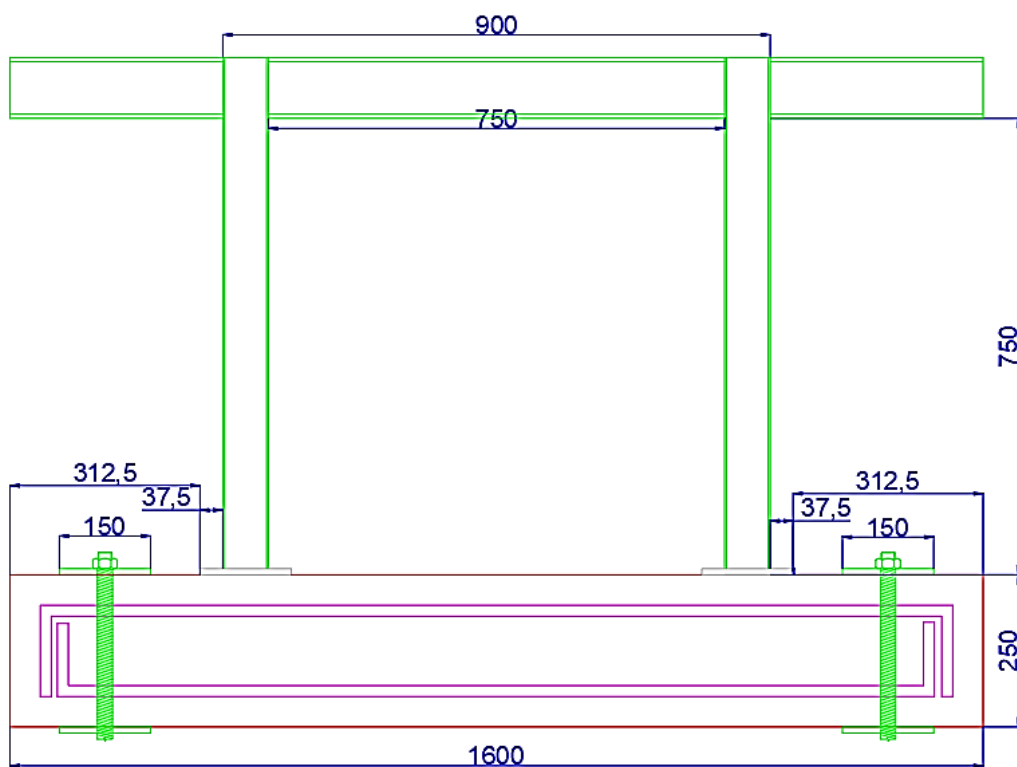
Pórtico de Acero Estructural de 75cm x 75cm sin relleno.
